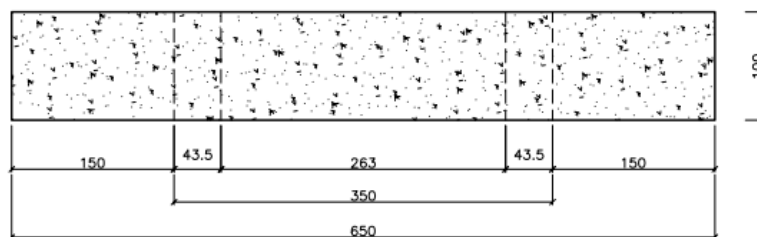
Planta da viga sem aço (dimensões em mm).
